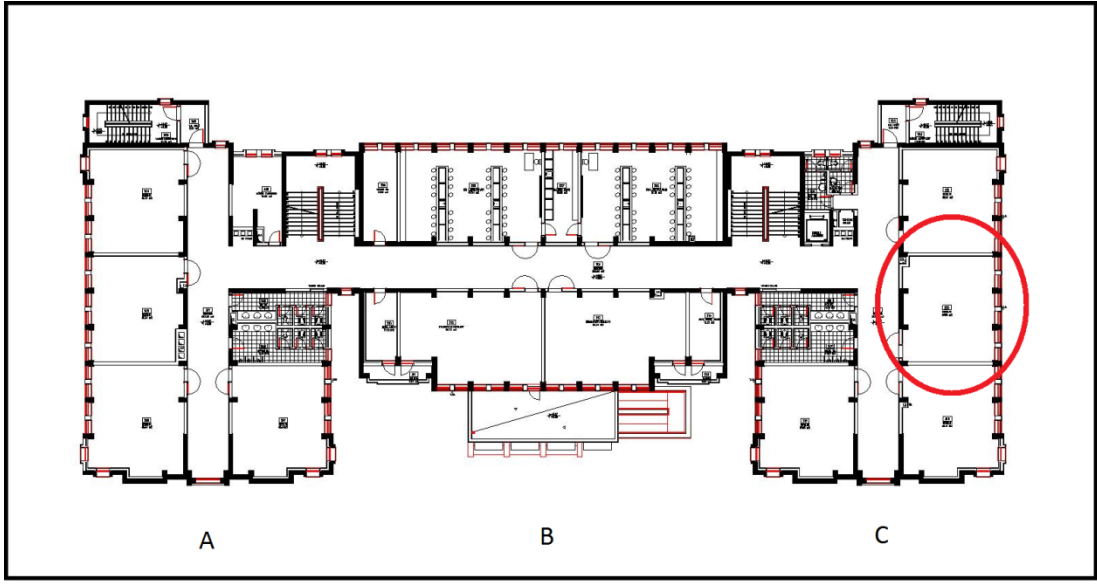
Doğa Koleji Çukurambar 2. Kat Planı A ve B blok (Çankaya Belediyesi Arşivi).
